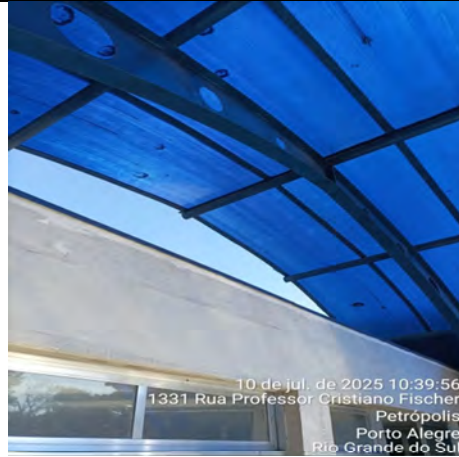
Calha metálica do rebaixo da cobertura instalada sem o rufo de proteção nas paredes e estruturas da edificação
